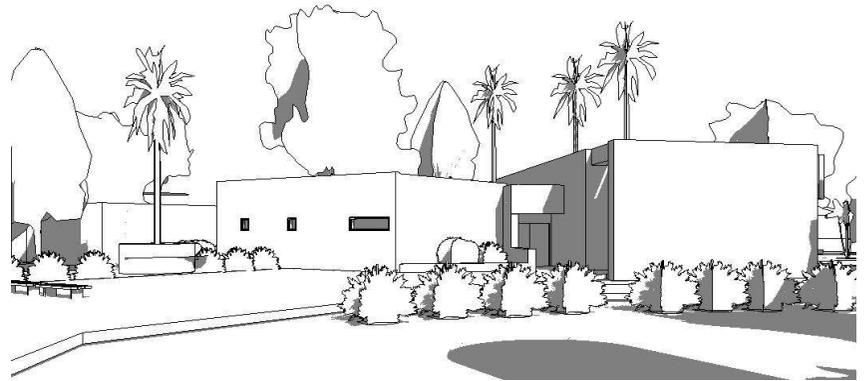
Módulo de trabajadores visto desde el área de plantas exóticas
